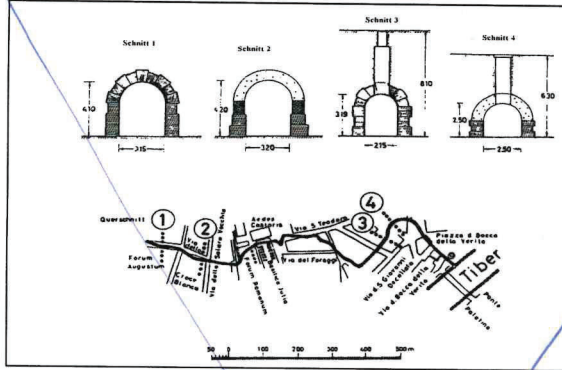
Cloaca Maxima in Rom (Grundriss und Querschnitt)
